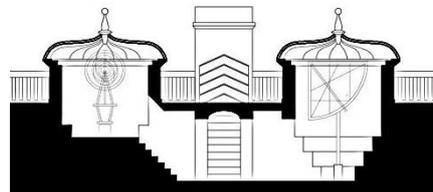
Observatorio de Stjerneborg. Sección.
